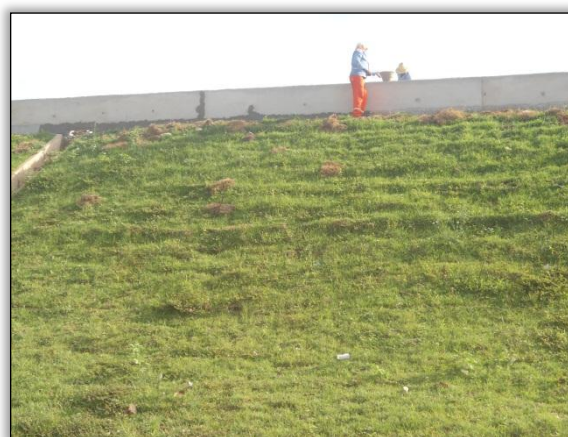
Talude Recuperado e com implantação da barreira de New Jersey.
